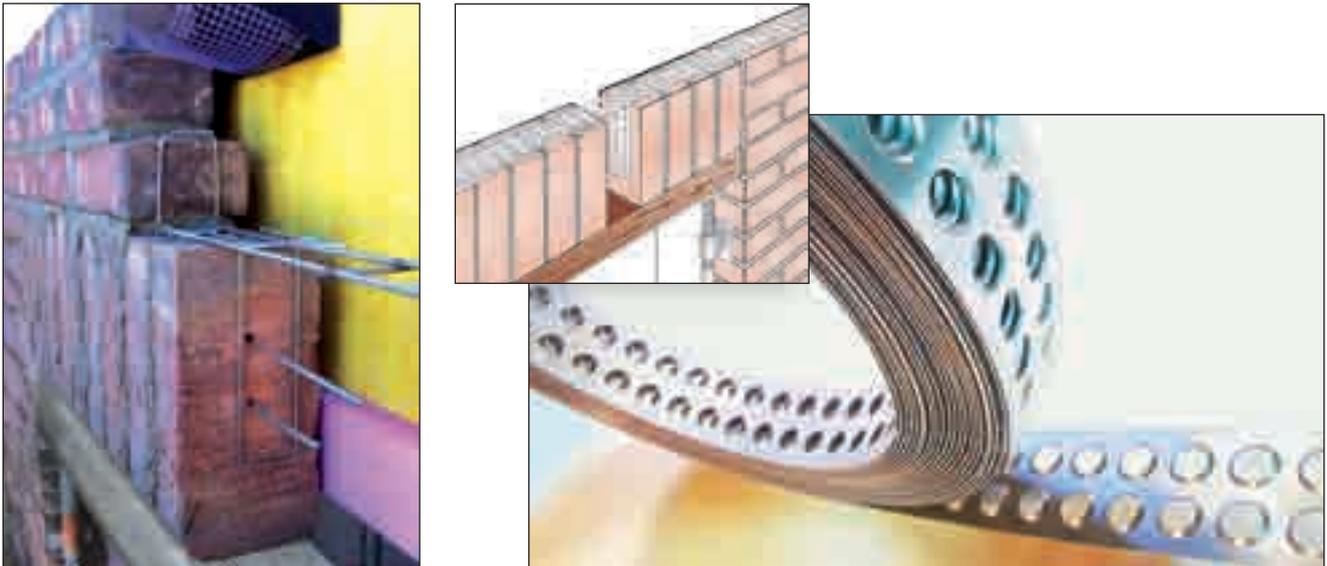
Bauseitige Herstellung eines Sturzes in der Außenschale eines zweischaligen Mauerwerks
